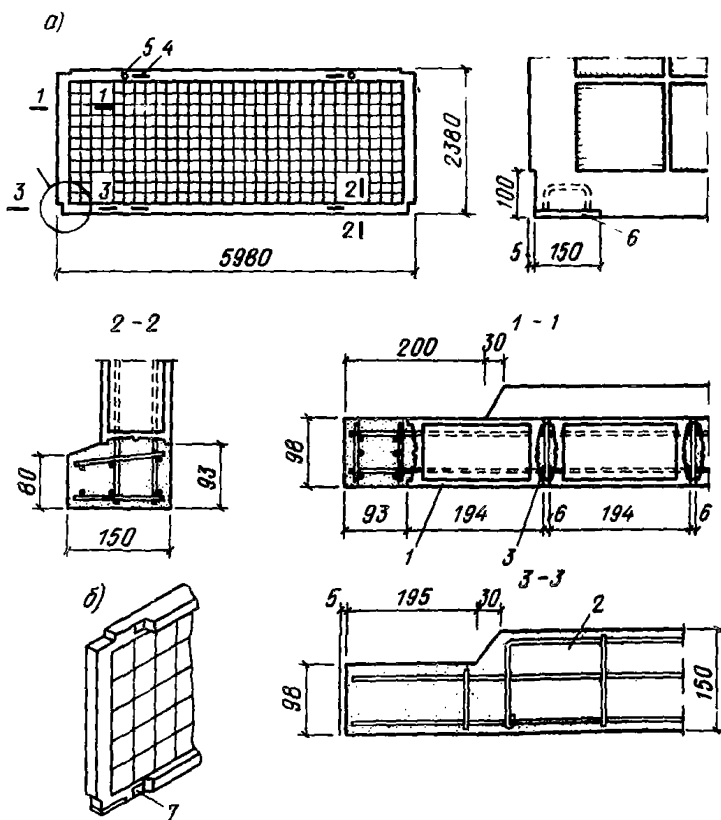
Стекложелезобетонная вертикальная навесная панель из стеклоблоков БК 194/98 с уширенными продольными обвязками
